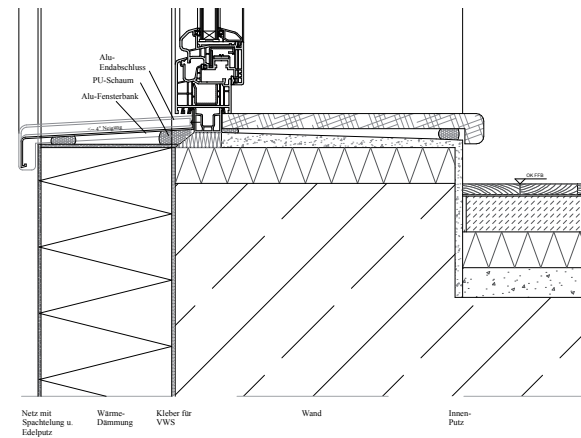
Fensterdetail Anschluss unten: M 1: 10
